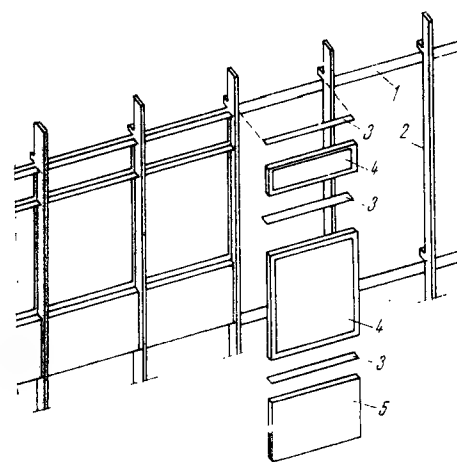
Panou pentru fațadă-cortină realizat din elemente separate, montate pe rigle verticale:
